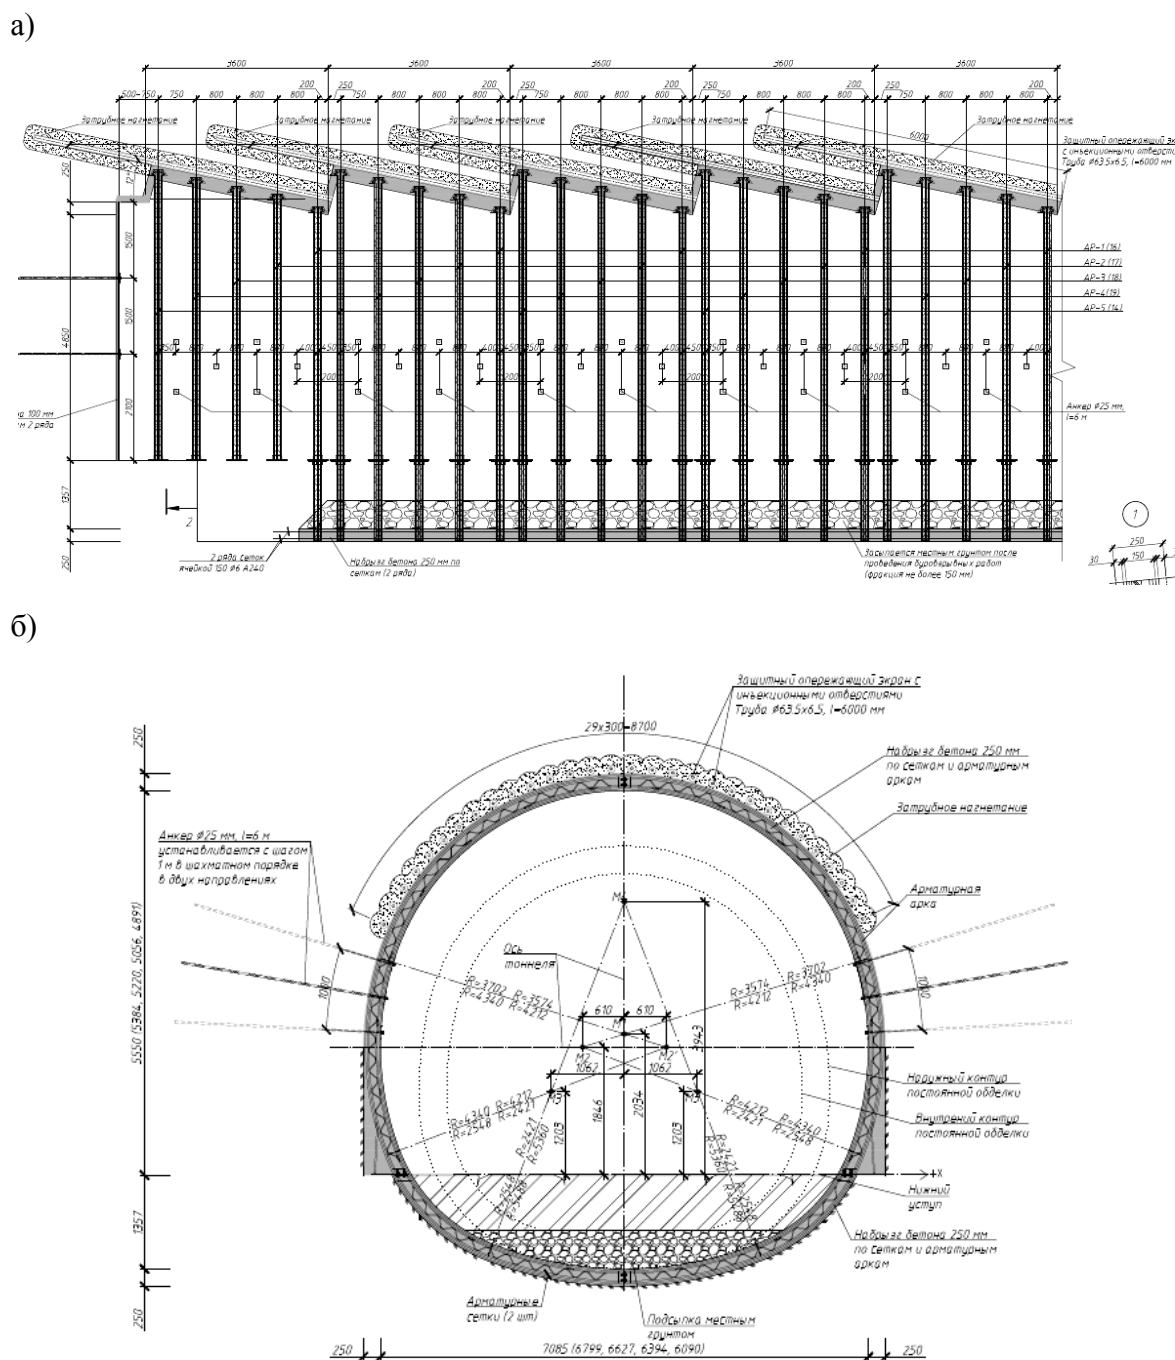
поздовній (а) і поперечний переріз (фрагмент) (б) Class-Va
